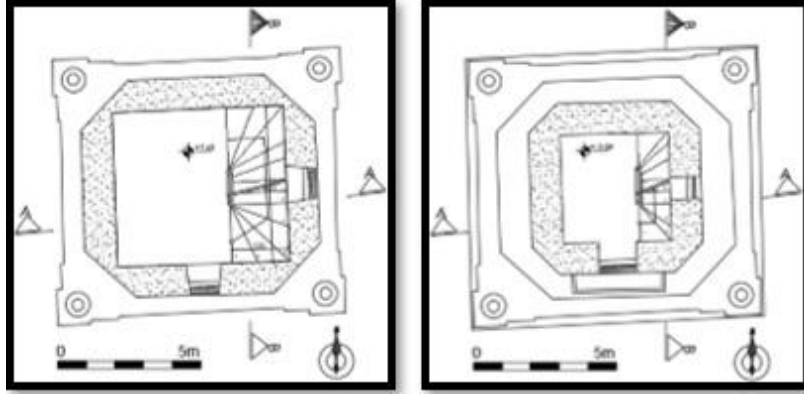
(sol) ±0.00 kotu Planı, (sağ) +4.46 kotu Planı (Çizim; Dere, M. E.)
